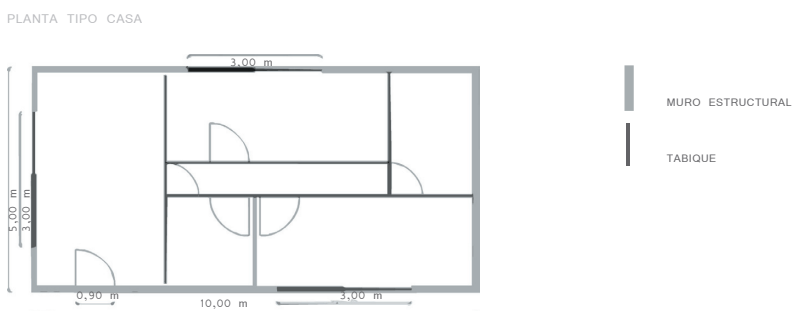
a: Planta de la vivienda tomada como ejemplo, casa básica de un piso.
